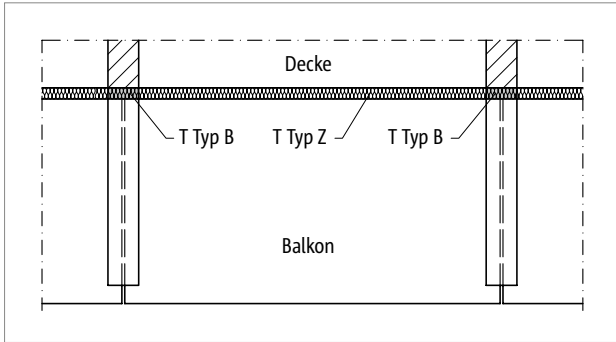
Schöck Isokorb® T Typ B: Balkonkonstruktion mit frei ausragenden Unterzügen (Fertigteilbalkon)
